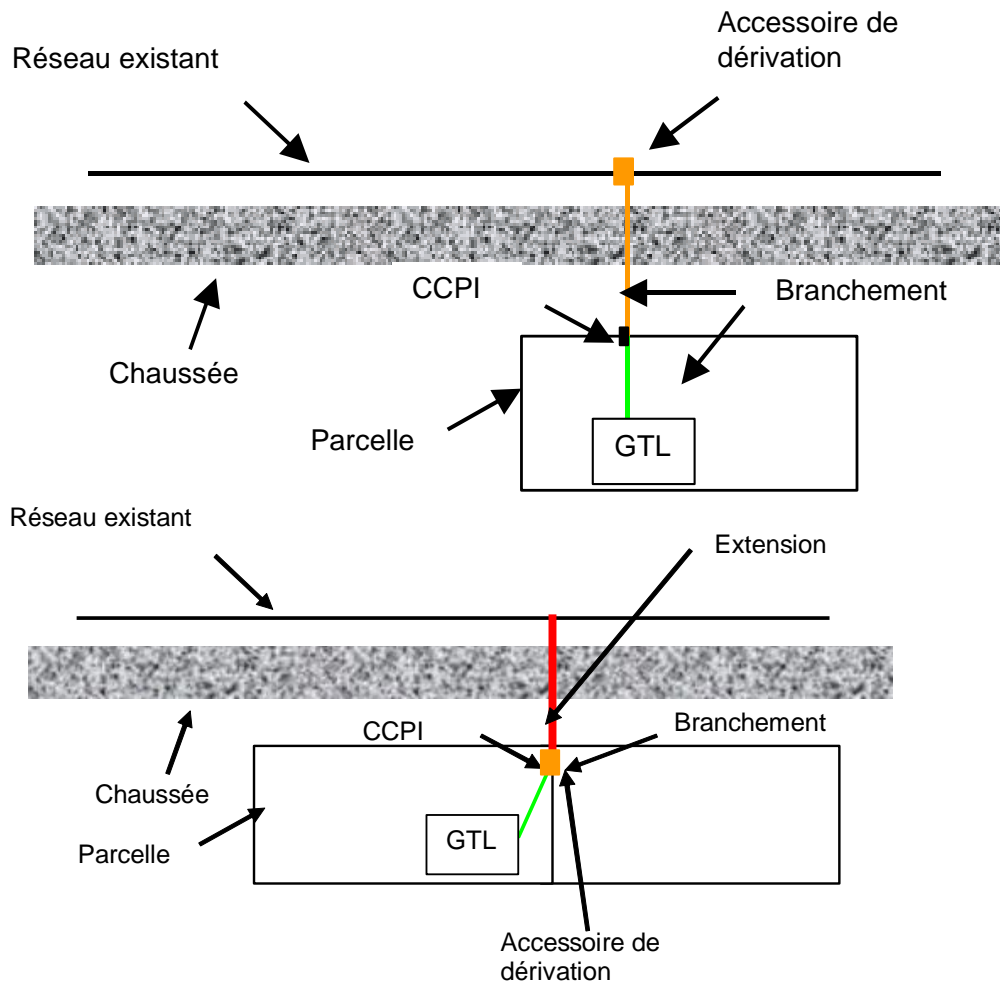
Raccordement individuel BT \leq 36 kVA avec traversée de chaussée
